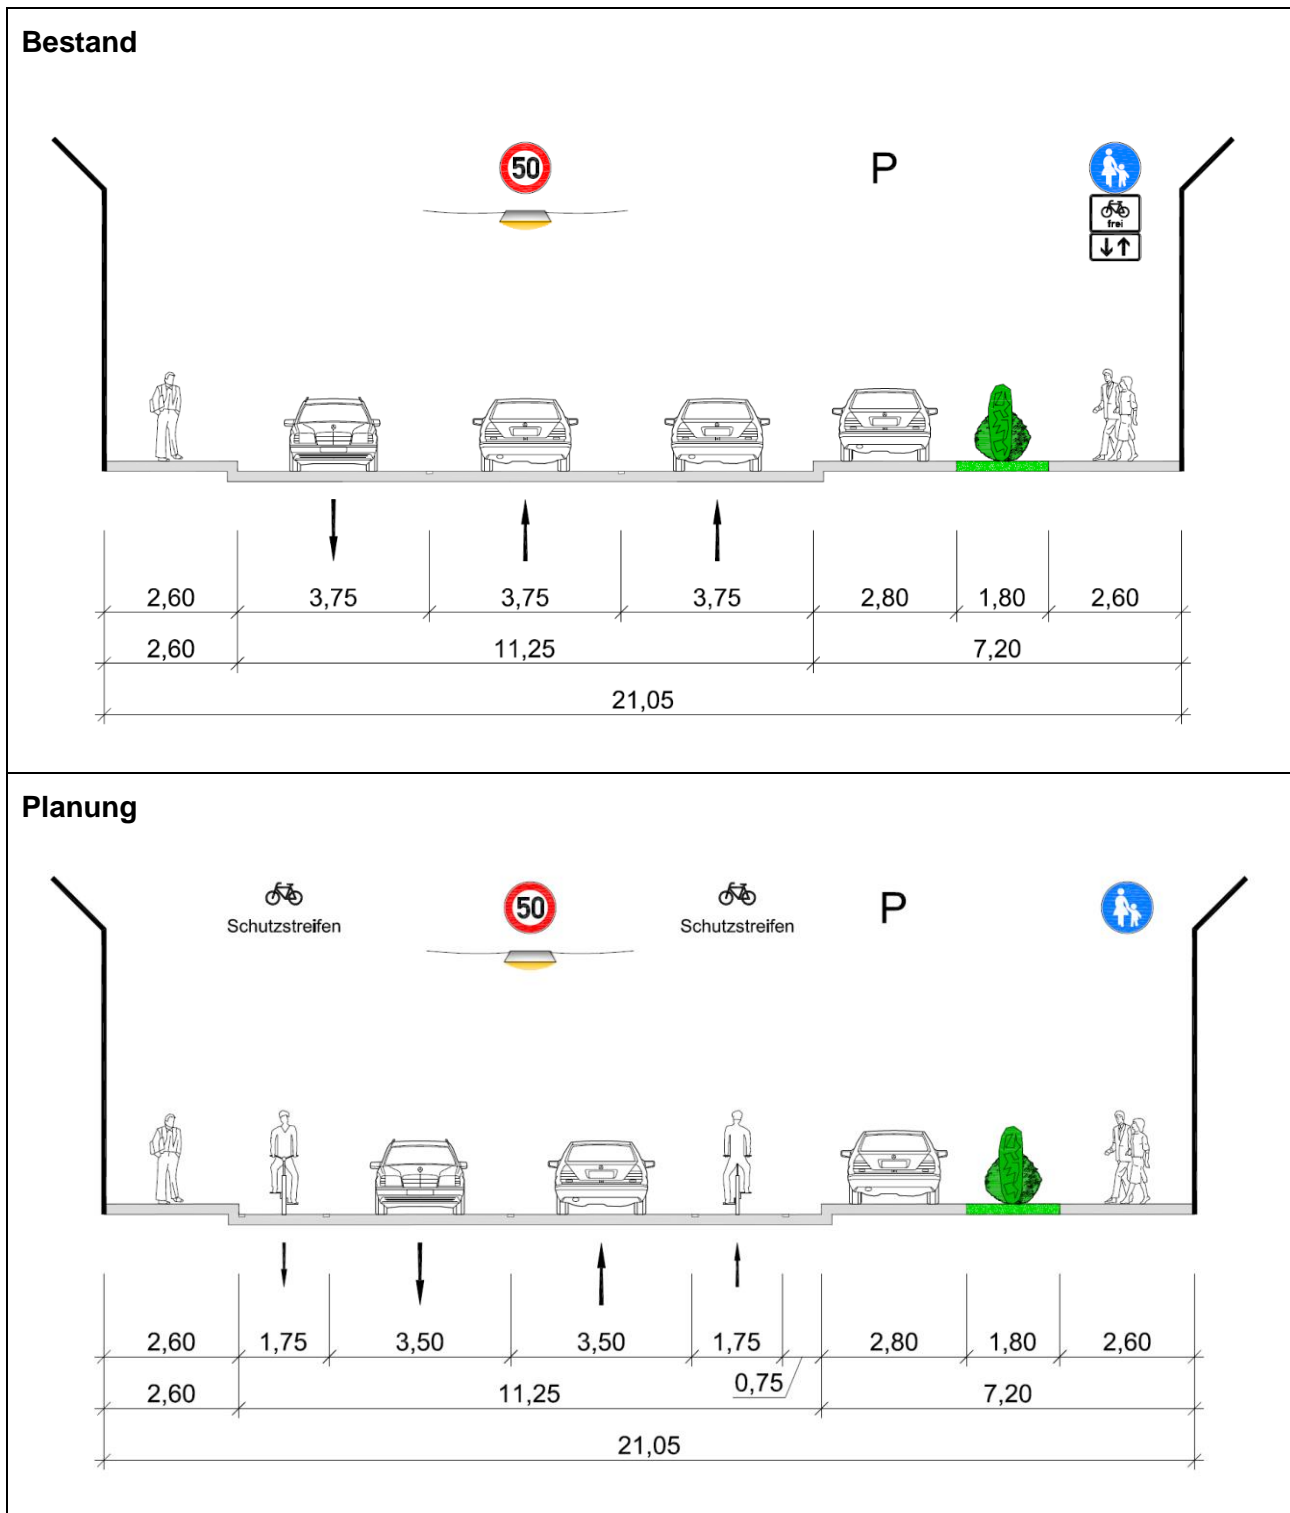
Kölner Straße (Höhe Heilenbecker Straße) – Bestand und Planung
